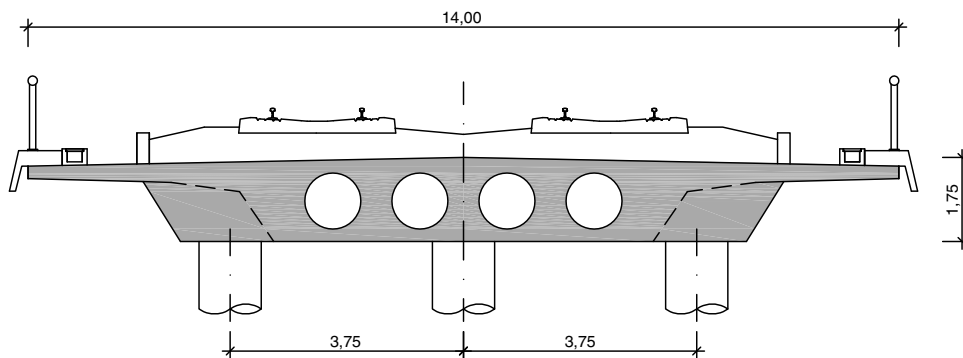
Sección sobre pilas Viaducto sobre CV-95.
